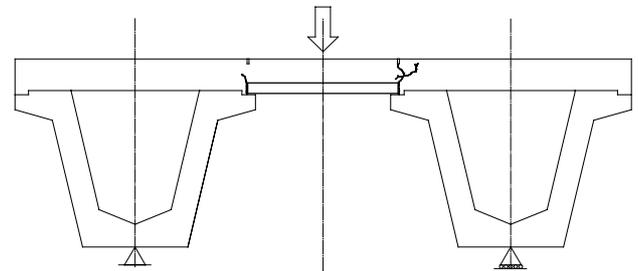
ひび割れ状況(疲労・588万回繰返し後)
